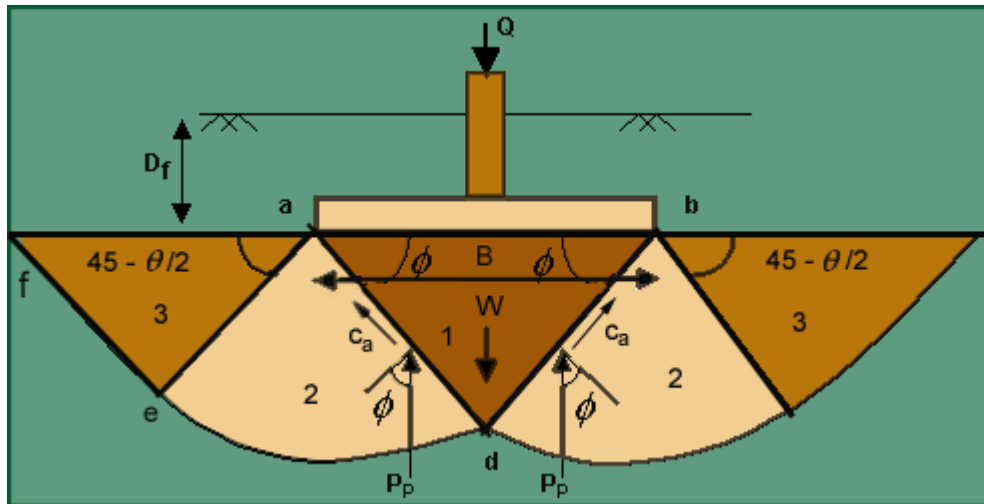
Mécanisme de rupture d'une fondation [6]
